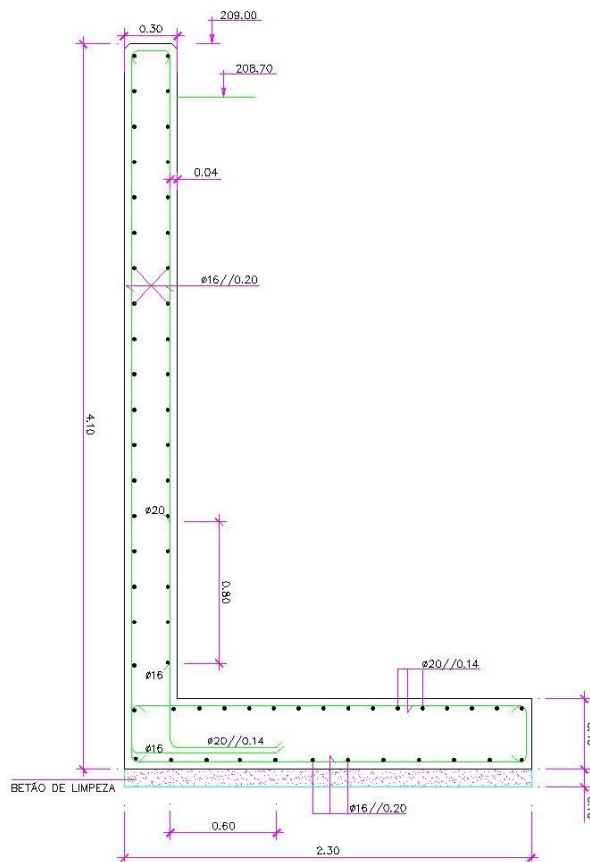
Pormenorização de muro de suporte da seção IV SE Amareleja
